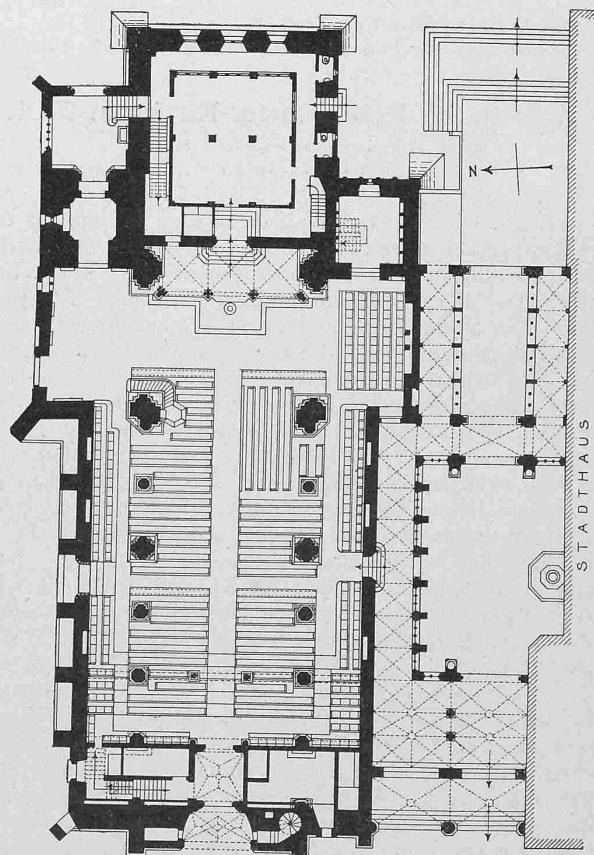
Grundriss der umgebauten Fraumünsterkirche mit dem neuen Kreuzgang und Brunnenhof gegenüber dem Stadthaus. — Massstab 1:500.
